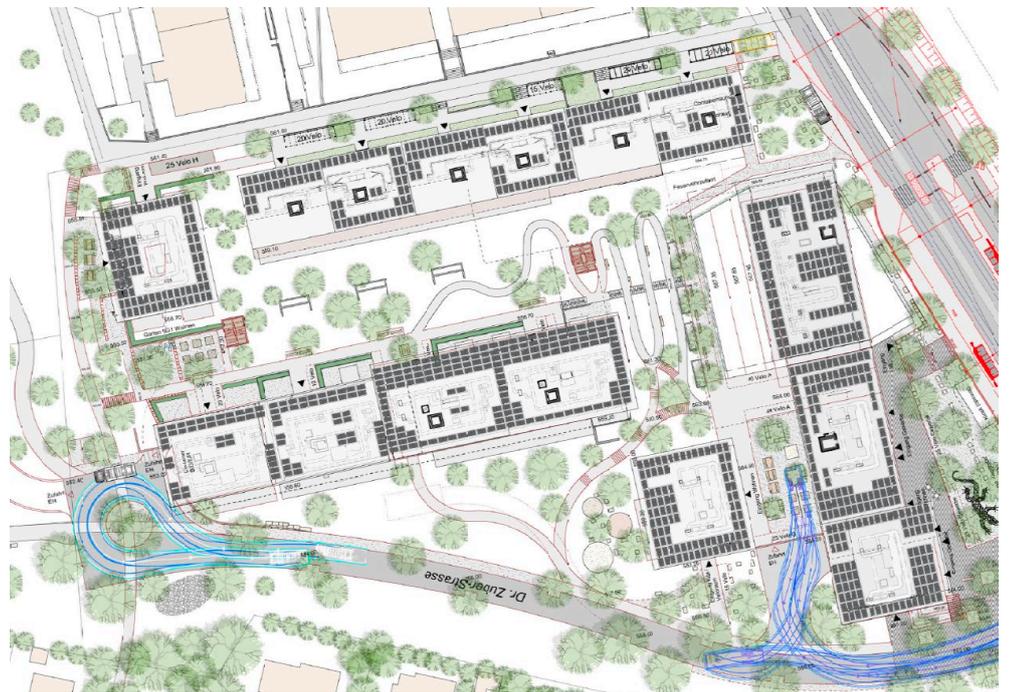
Dachaufsicht [Burkhalter Architekten AG]
